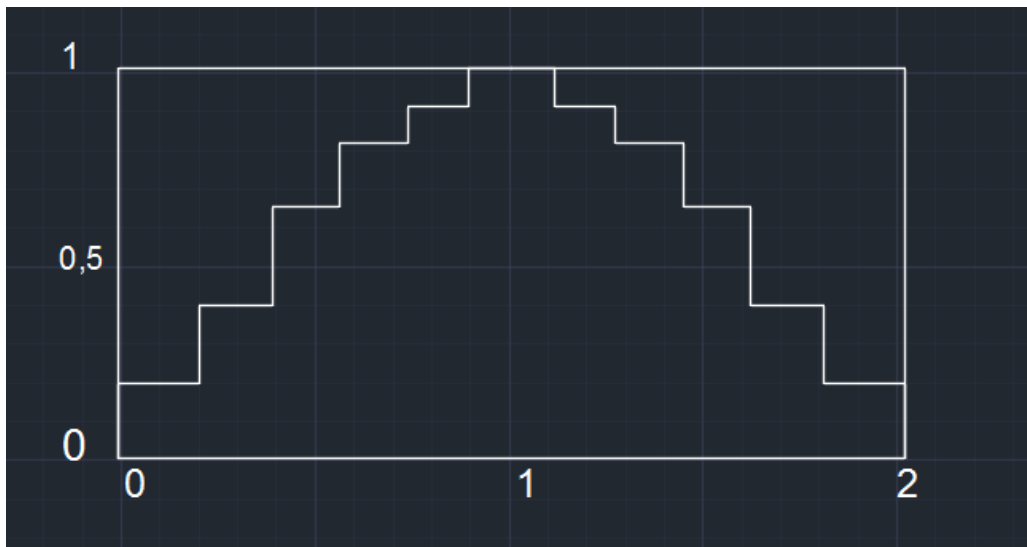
SCHEMA D'UN MERLON EN ESCALIER - AUTOCAD CAMILLE RUE
